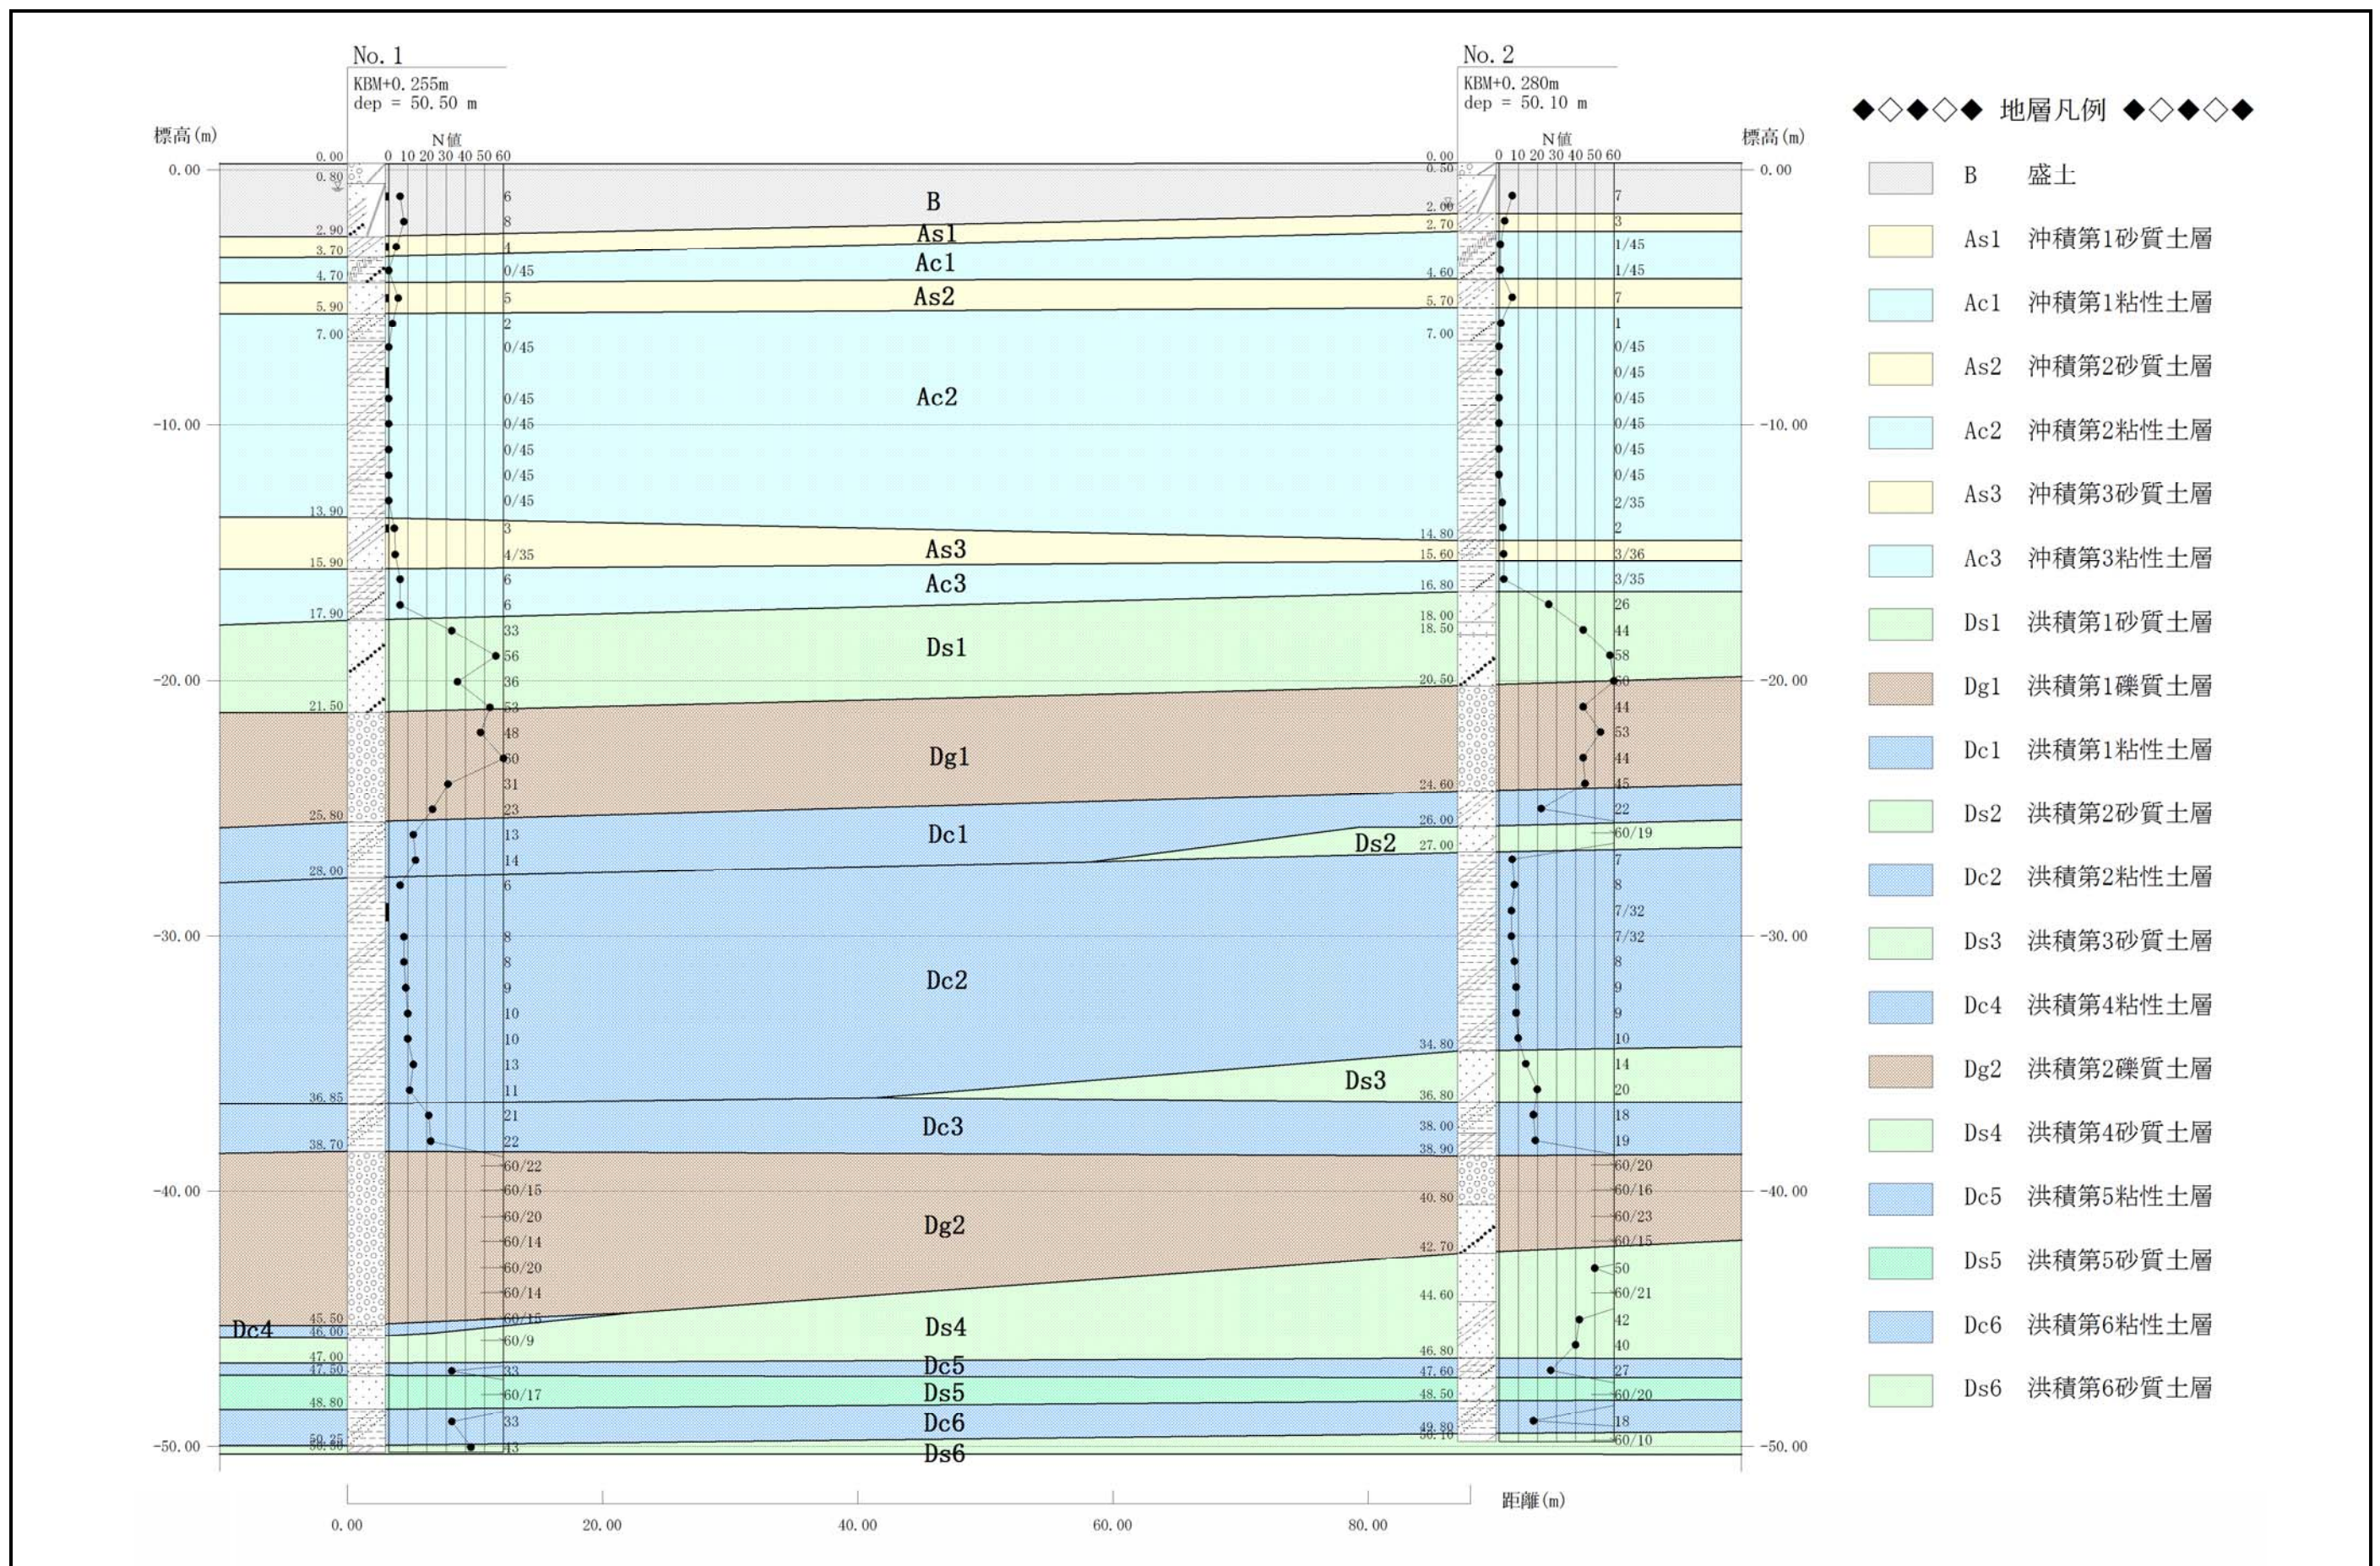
調査位置平面図および地層推定断面図 (断面図 S=1:250 平面図 S=1:500)
